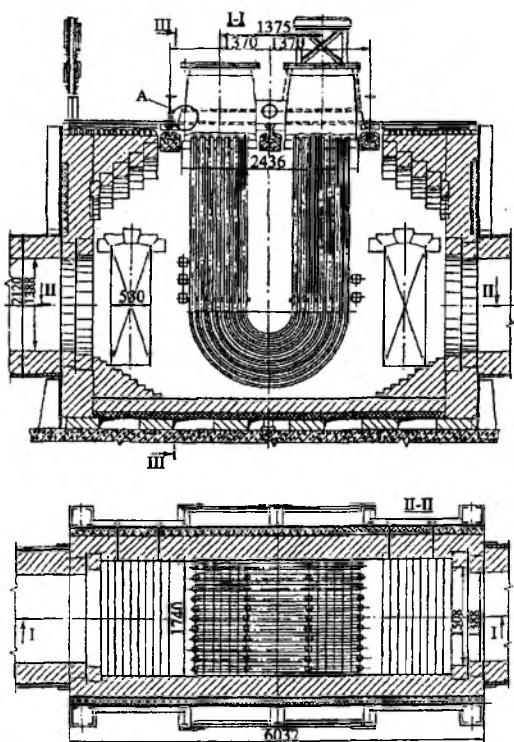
Компоновка петлевого трубчатого металлического рекуператора в газоходе (борове) крупной нагревательной печи металлургического завода
